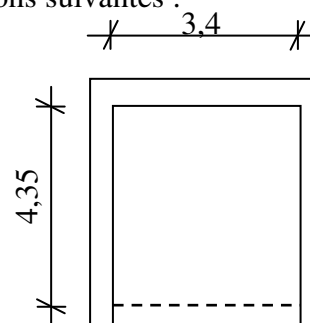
Dimensions du panneau de dalle le plus sollicité
